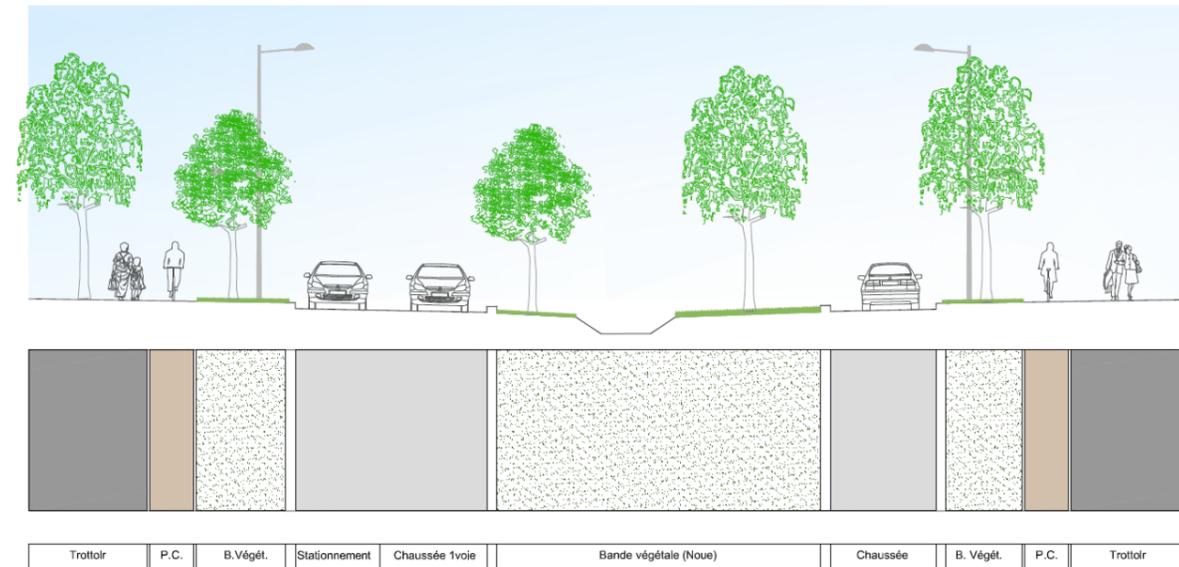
Coupe de principe sur le Boulevard de la Vauve
